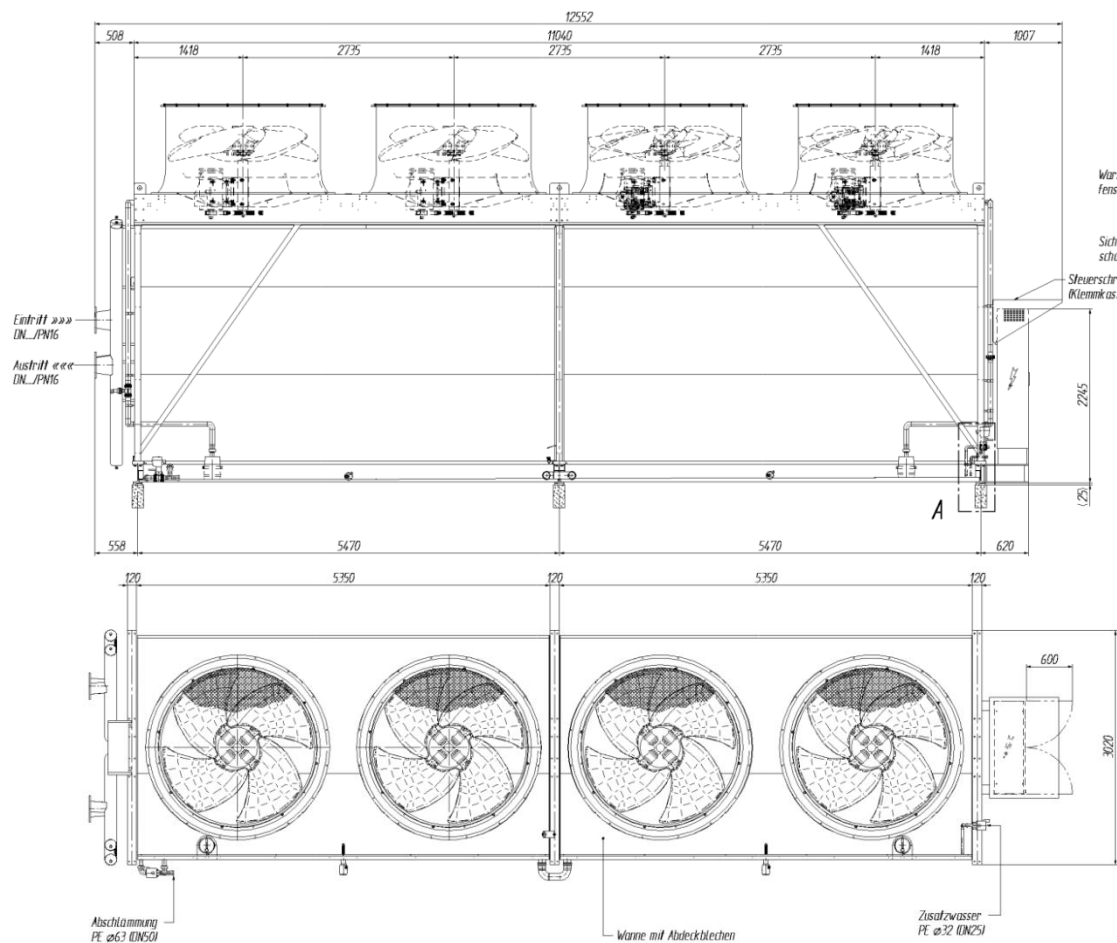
Hybridkühler - Technische Zeichnung, Hersteller: Jäggi Hybrid Technologie AG Typ: HTK 3.24/10.9-2S-S
